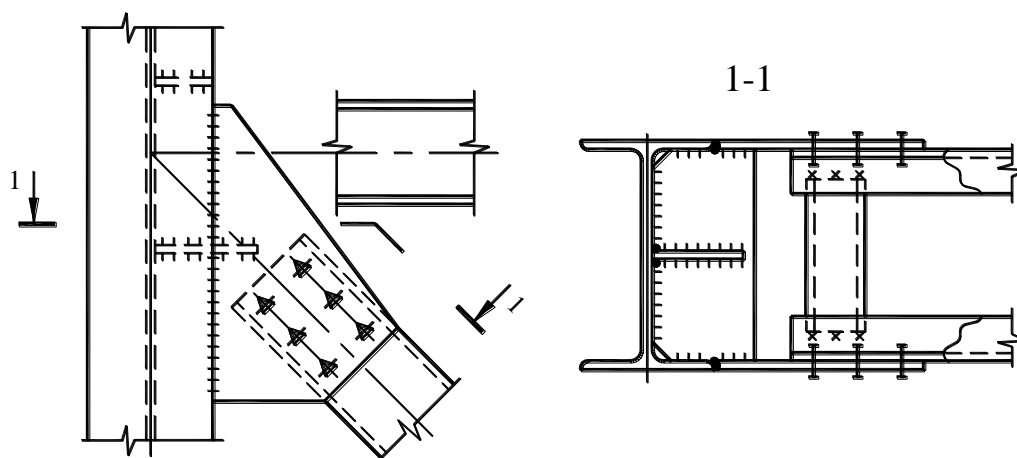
Узловое соединение связей на сварке
